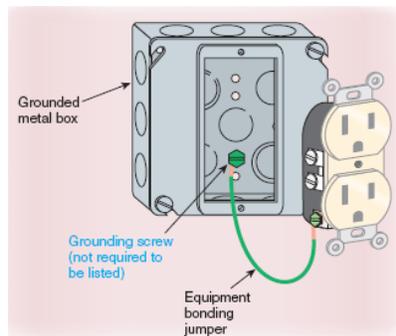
CONEXIÓN A TIERRA DE CAJA METÁLICA
